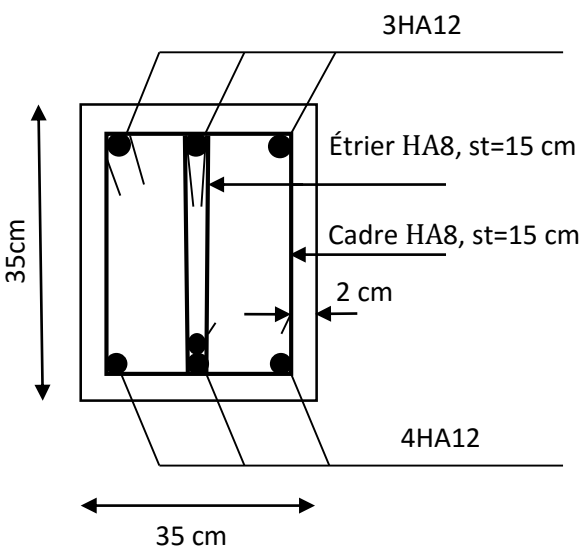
Schéma de ferrailage en travée de la poutre palière.
